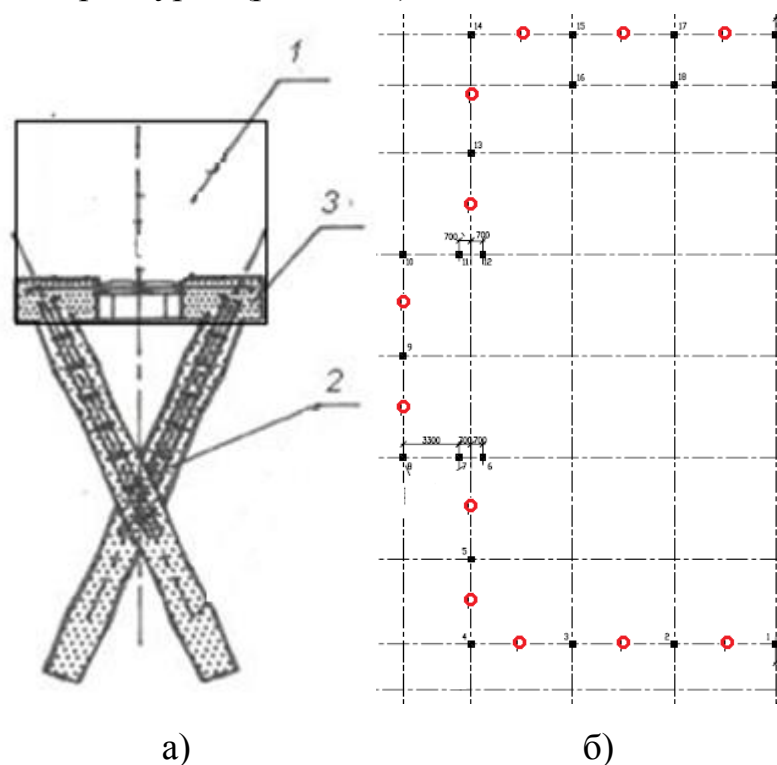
Установка буронабивных свай со стеклопластиковой арматурой:
